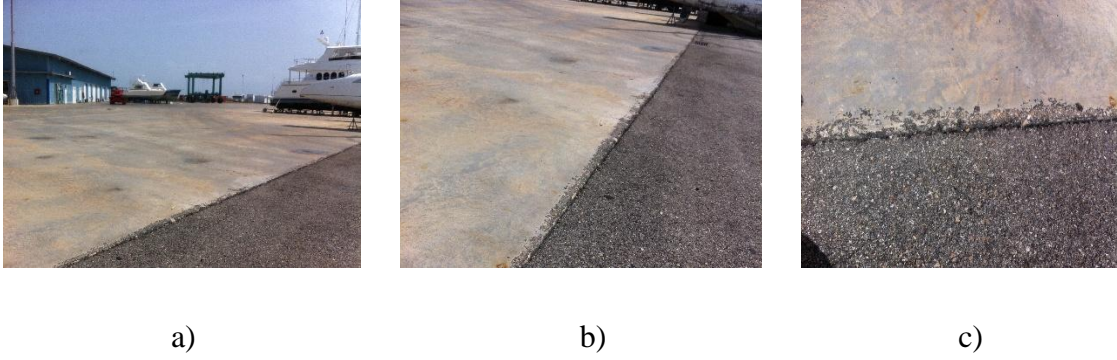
Zona de transición. Fuente: Elaborado por la autora
